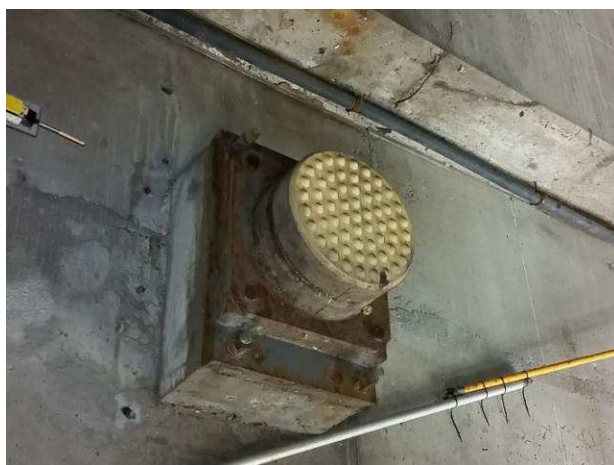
att. Pretsvara stabilizators (pretsvara piekāršanas ass mezgls). Defekti: tērauda elementu un stiprinājumu korozija, kā arī laiduma konstrukcijas sijas korozija.
